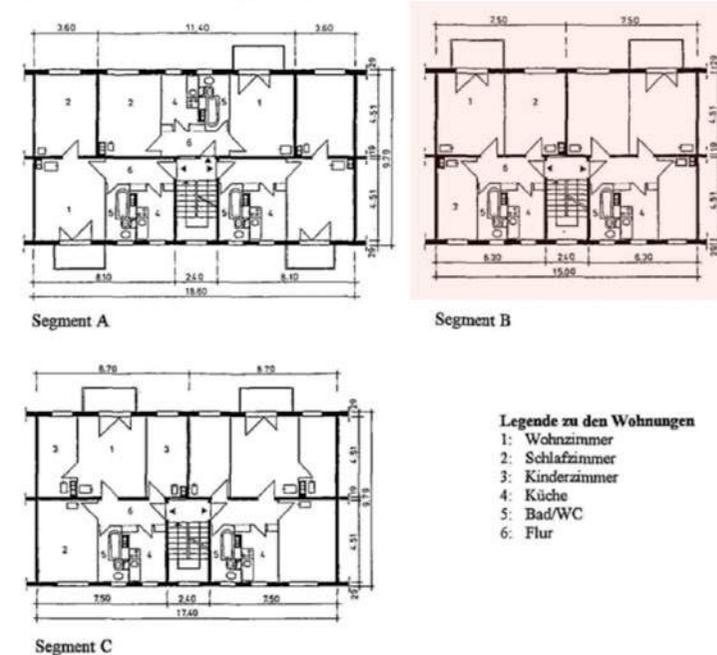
Grundrisse im Typ IW58 Zeulenroda (Schulze, 1996)
